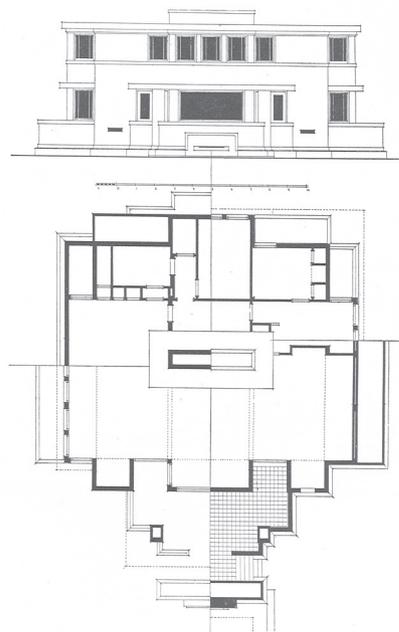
Pianta e prospetto, in *De Stijl*, vol. 2, n. 7, maggio 1919.
